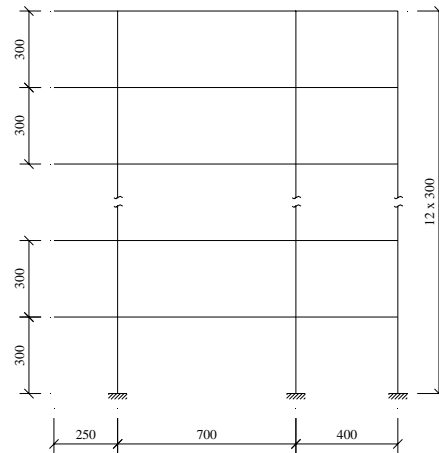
Pórtico composto de doze pavimentos e três pilares
